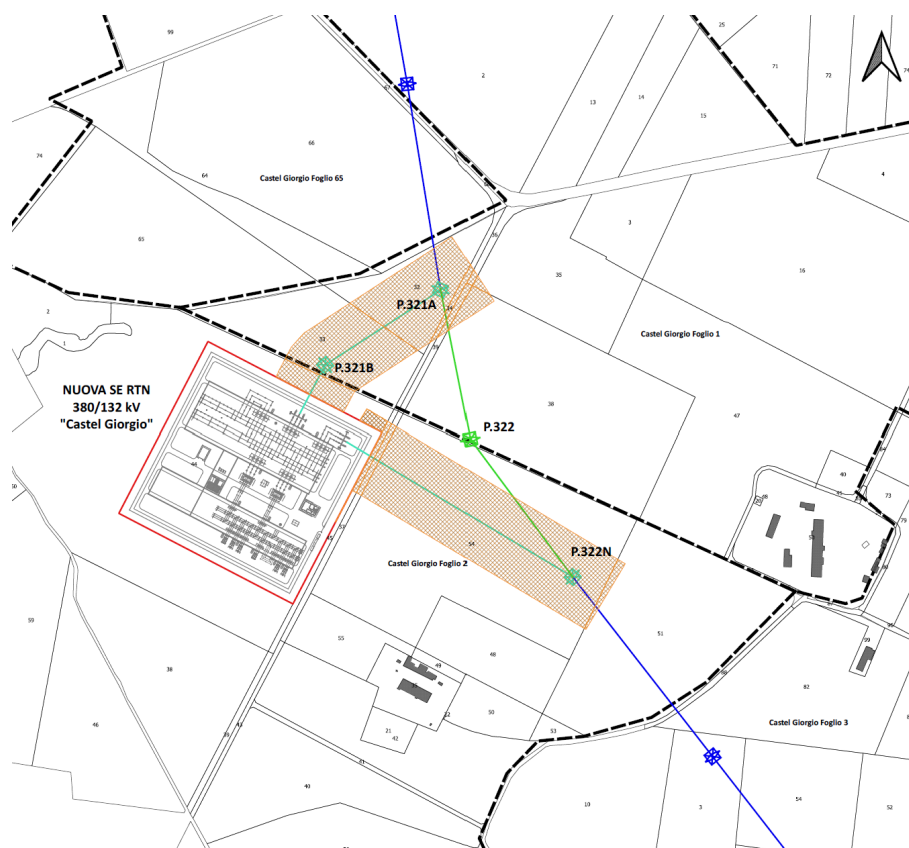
Planimetria catastale dell'impianto con evidenziate le fasce di rispetto degli elettrodotti aerei di raccordo.
